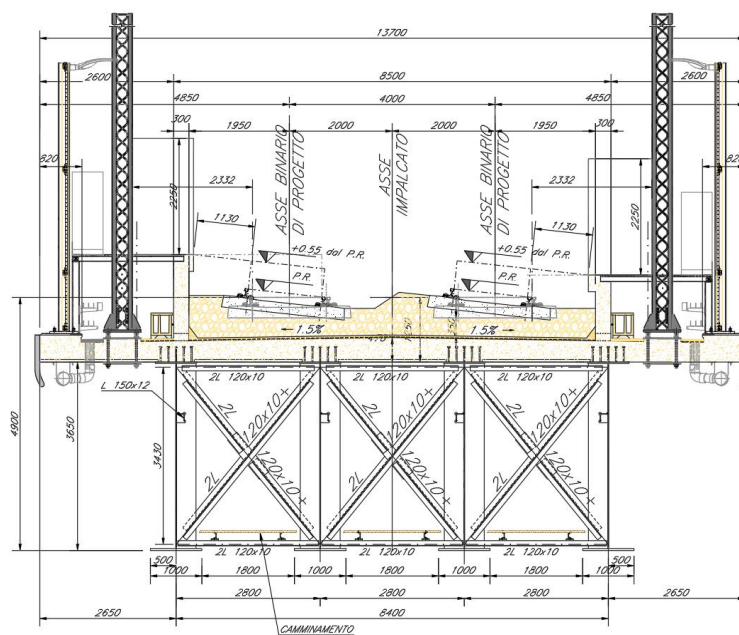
Sezione trasversale tipo (H travi = 3.65 m)
